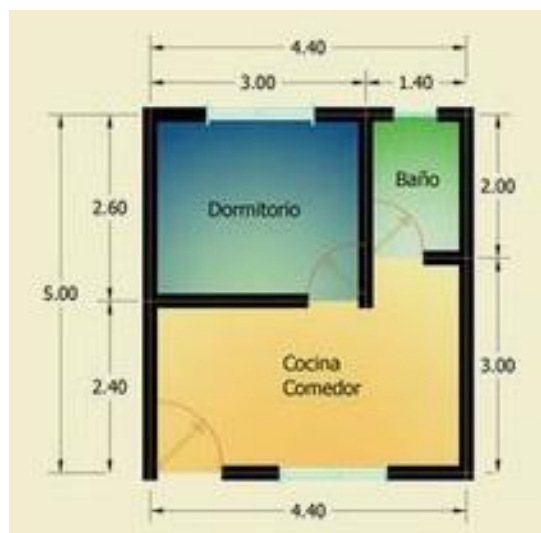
Arquitectura de los apartamentos, 1ª planta.
